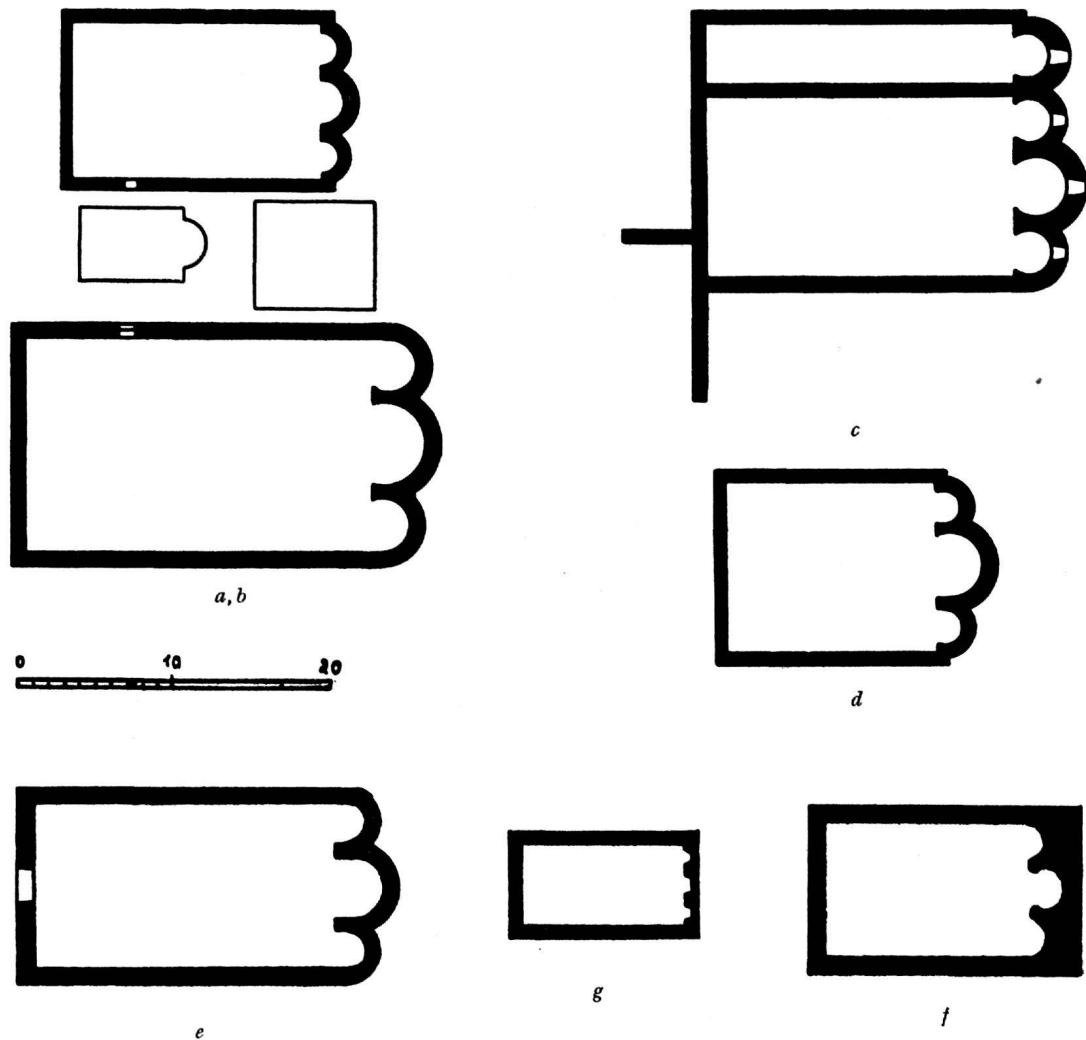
Grundrisse der Saalkirchen in Churrätien
